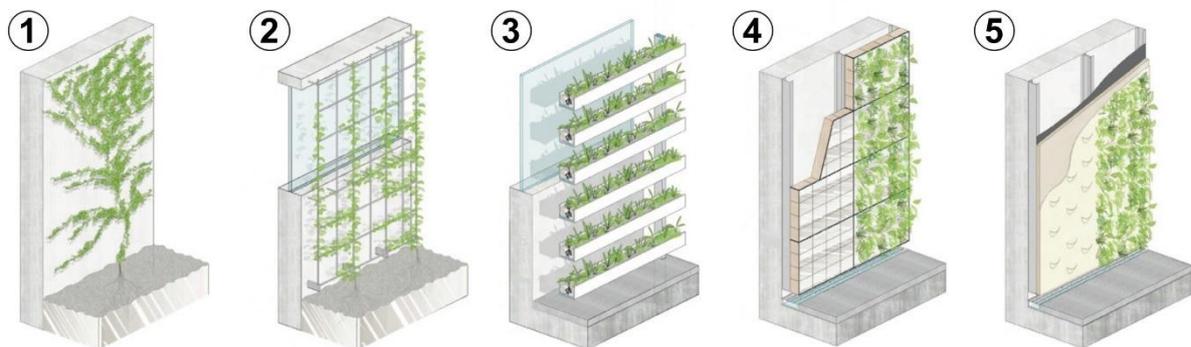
Ausbildungsformen von Fassadenbegrünungen. 1) Direktbewuchs mit Selbstklimmern, bodengebunden, 2) leitbarer Bewuchs an Kletterhilfen, bodengebunden, 3) Pflanzgefäße, horizontale Vegetationsflächen, wandgebunden, 4) modulares System (Living Wall), vertikale Vegetationsflächen, wandgebunden, 5) flächiges System (Living Wall), vertikale Vegetationsflächen, wandgebunden (basierend auf Bildquelle: Pfoser [5])
